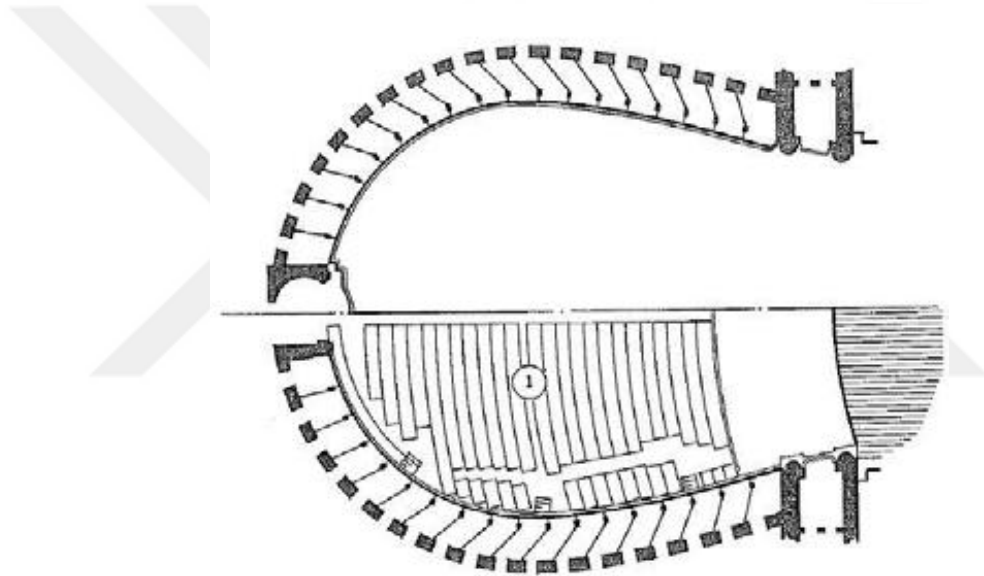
Değişik Plan Tiplerinin Yararlı Yanıl Yansımalarının Karşılaştırılması
